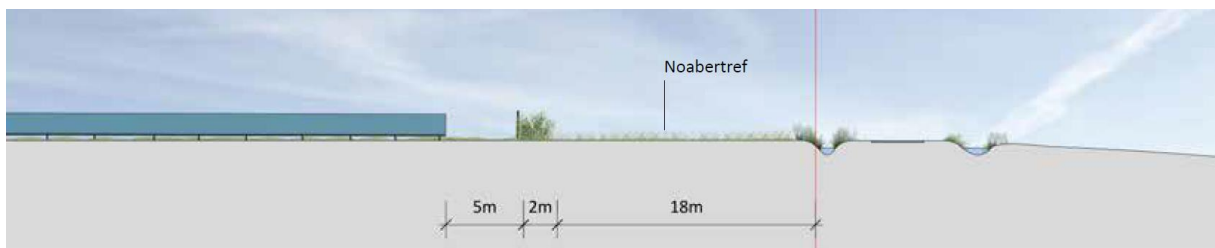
Weergave overzichtstekening inrichtingsplan (in het separaat bijgevoegde inrichtingsplan is een beter leesbare versie opgenomen).
